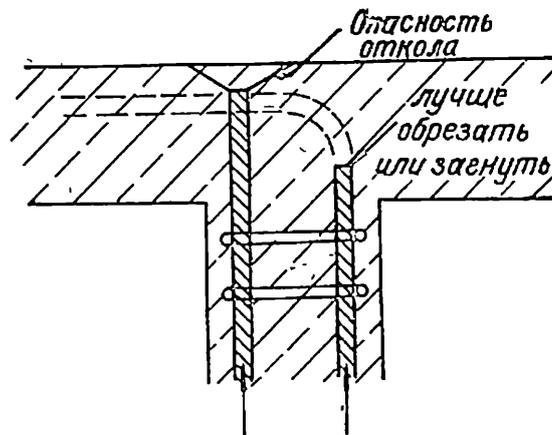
38. Оформление оголовка стальной стержней для свободной поверхности бетона
